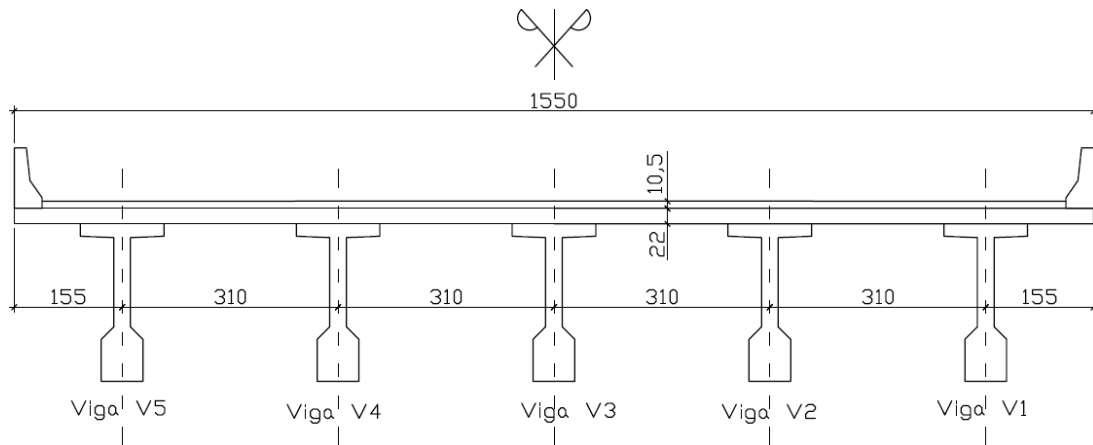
Seção típica do vão, S2 a S10, da planta de fôrma da ponte rodoviária
